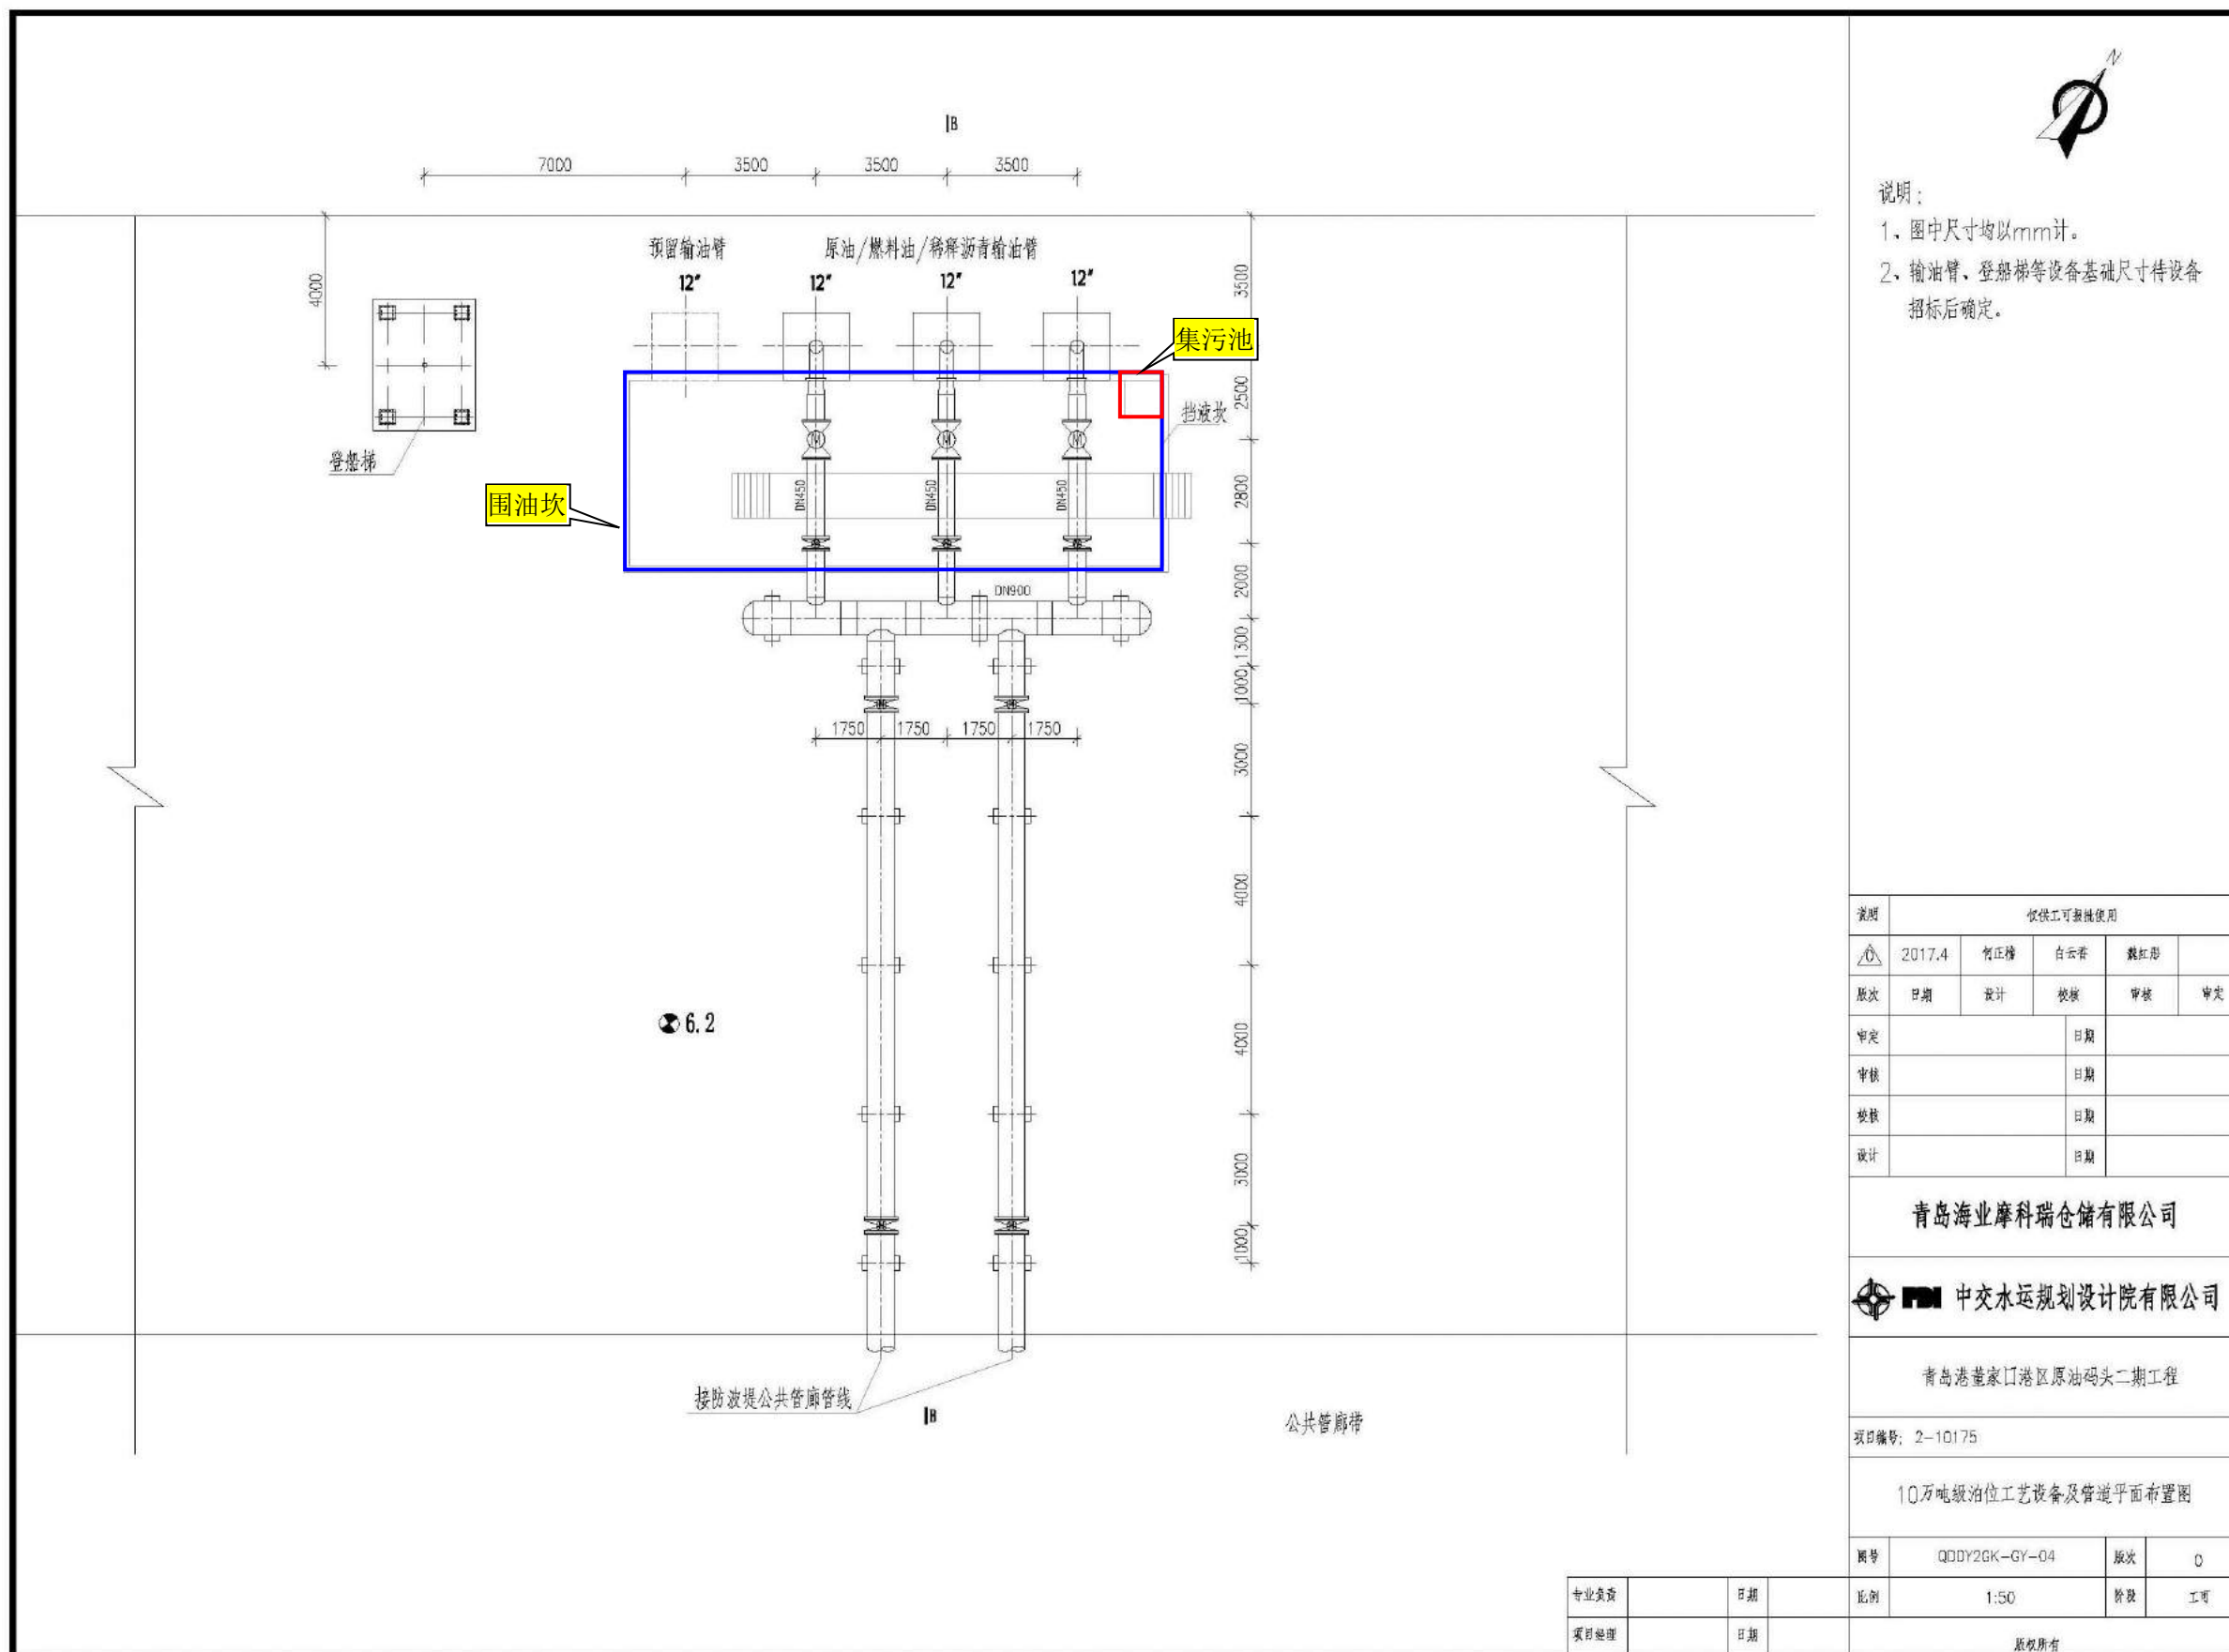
30 万 t 级码头工艺管线及设备平面布置图
